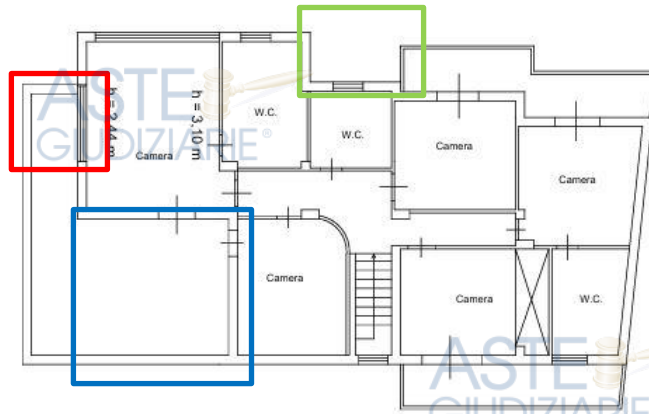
Planimetria Sub 7 Piano 1° Progetto Urbanistico
